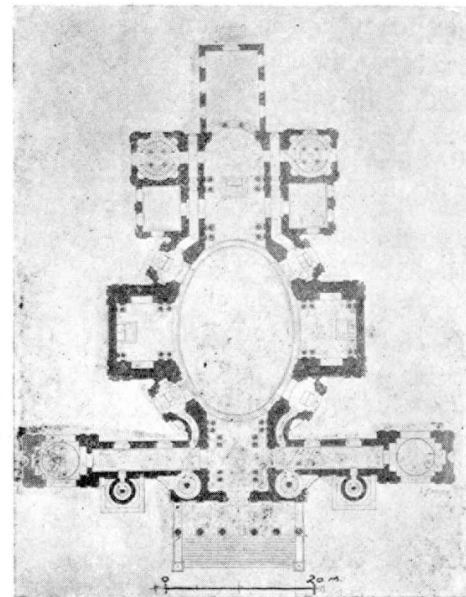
Plan kościoła św. Piotra w Wiedniu.
